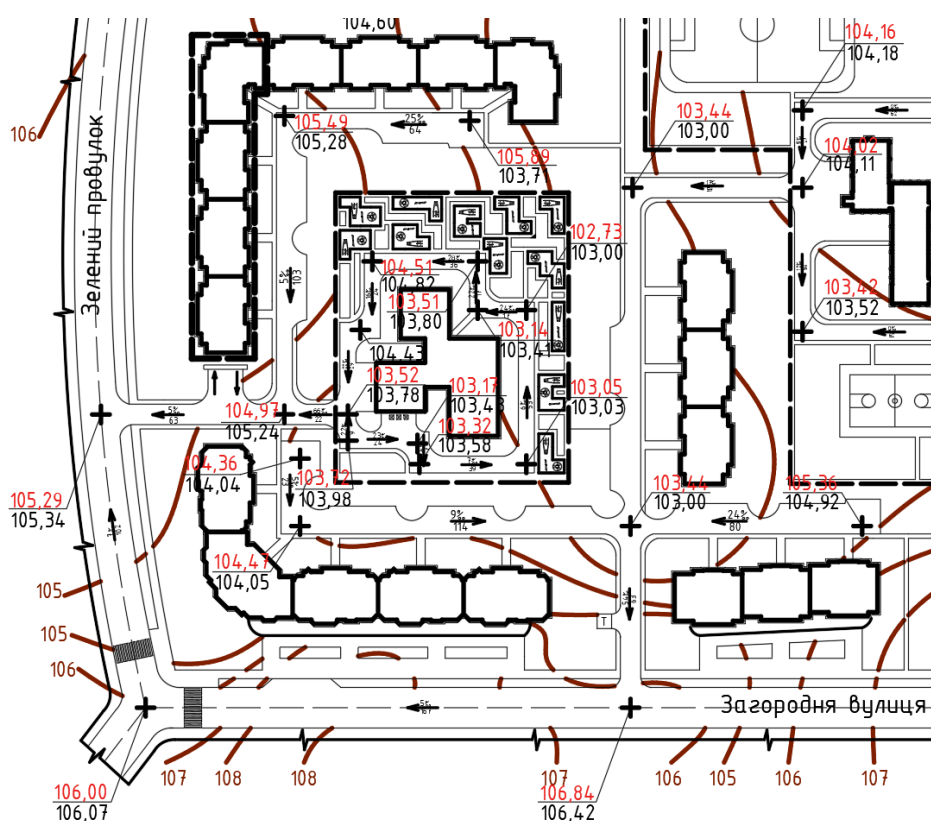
Фрагмент ділянки вертикального планування мікрорайона
